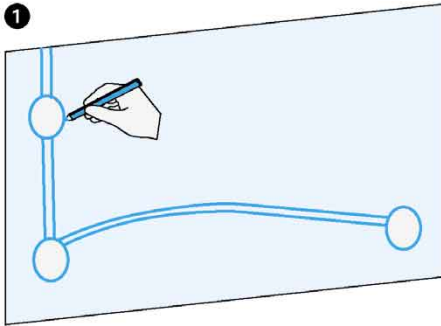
Les boîtes DCL pour plafond plein et applique murale
